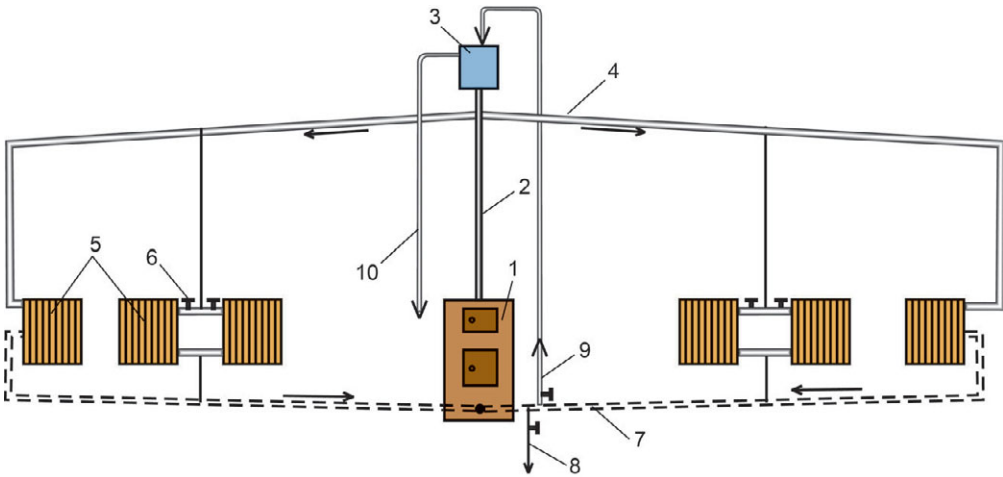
Схема двухтрубной системы отопления: 1 — котел; 2 — главный стояк; 3 — расширительный бачок; 4 — разводящая линия горячей воды; 5 — нагревательные приборы; 6 — кран двойной регулировки; 7 — обратная линия; 8 — вентиль с патрубком для спуска воды из системы; 9 — подпитка системы из водопровода или от ручного насоса; 10 — переливная линия (уклон труб показан стрелками)
